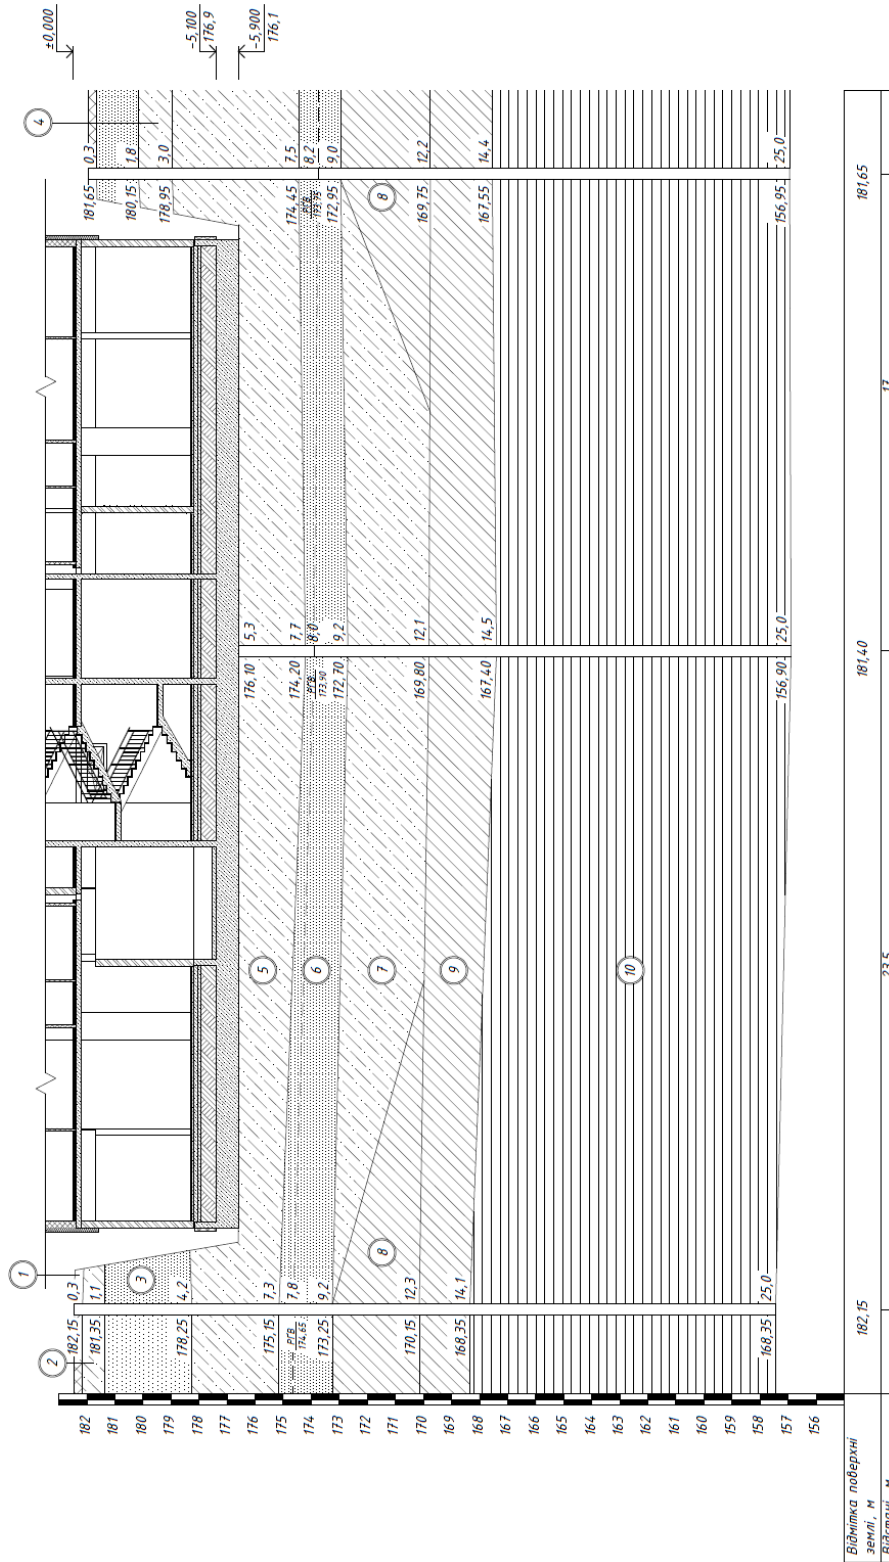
Посадка плитного фундаменту на ґрунт
